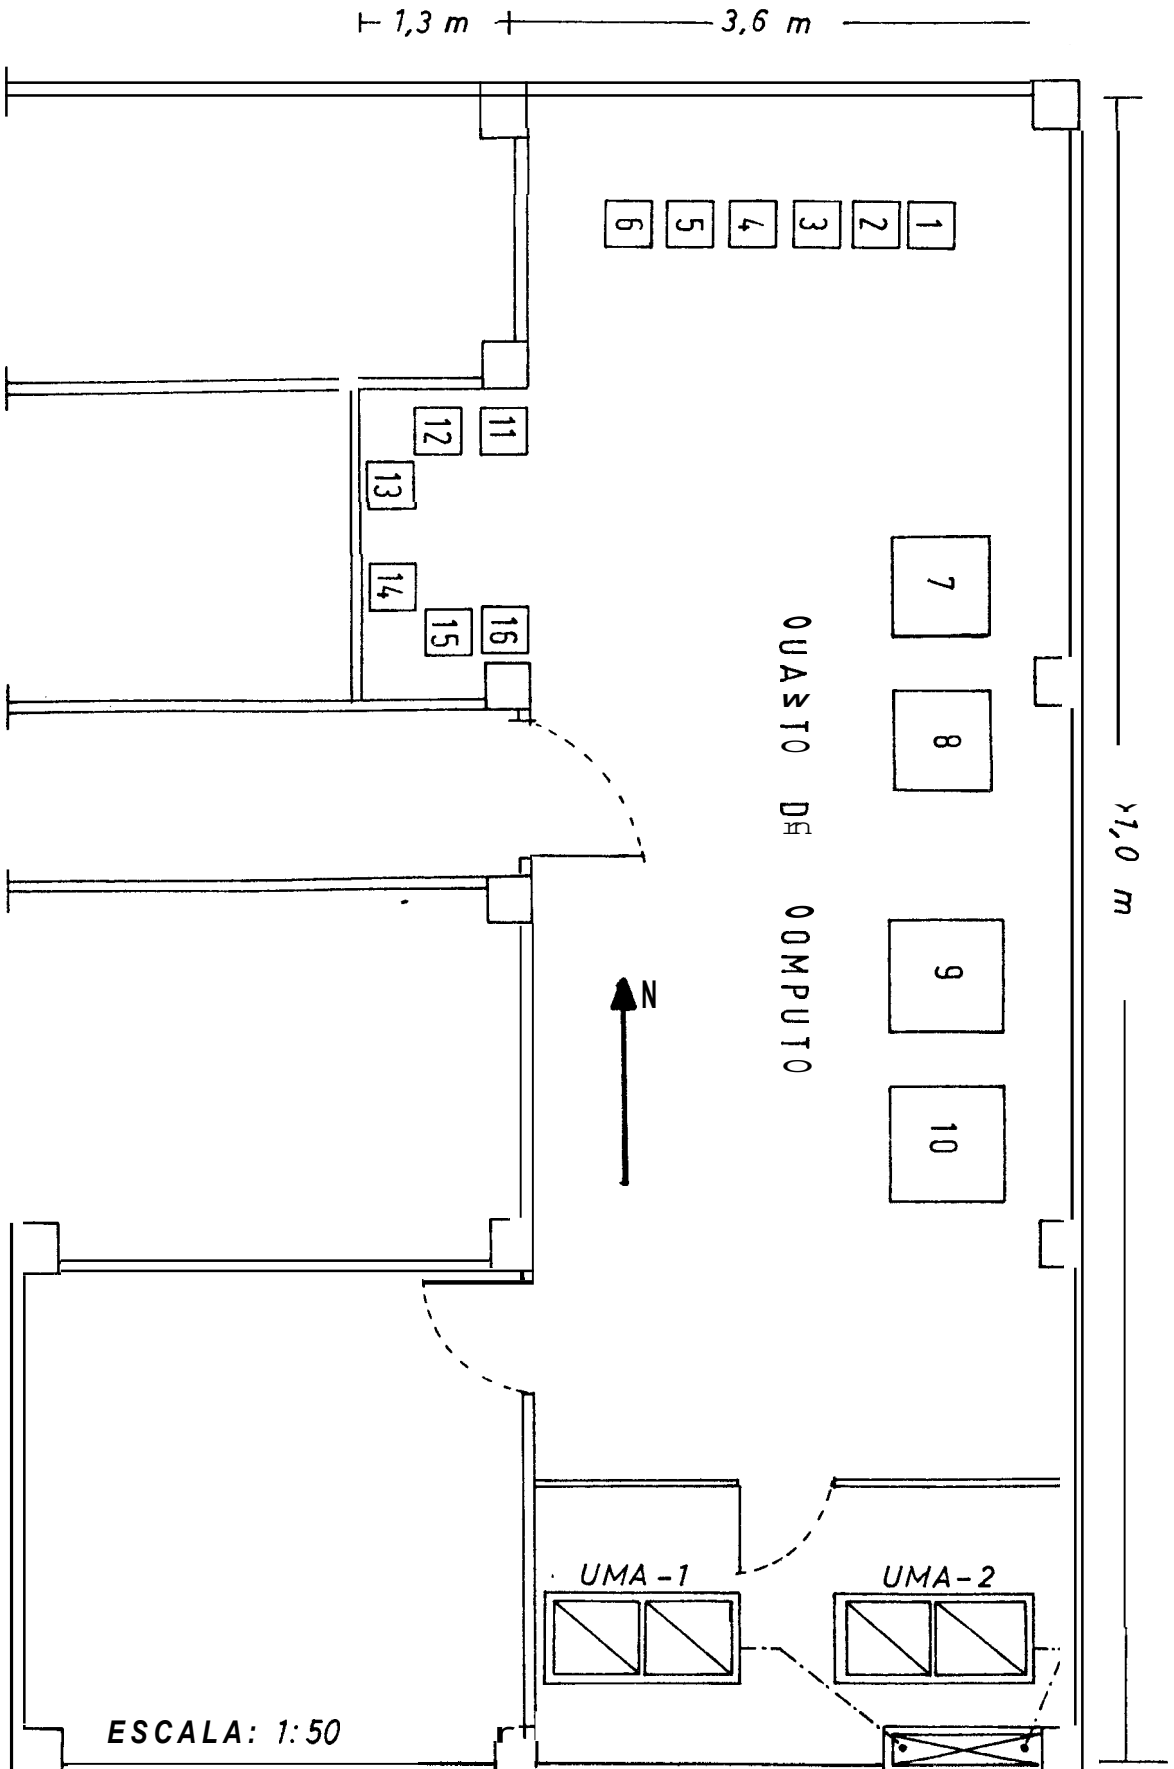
VISTA EN PLANTA DEL CENTRO V E COMPUTO.
